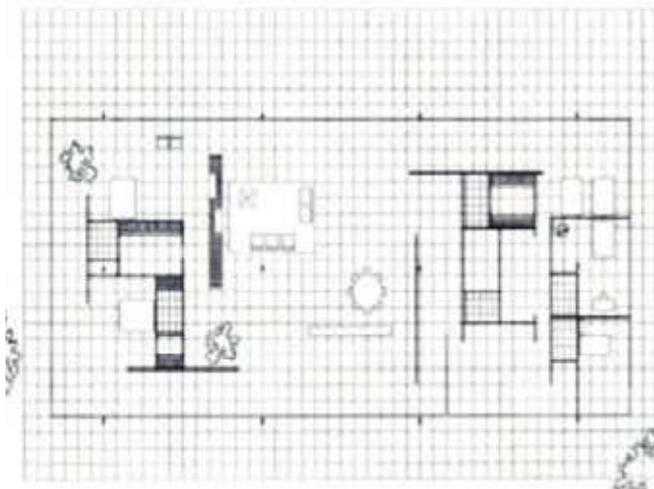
Grundriss Caine Haus, Projekt, Mies van der Rohe
